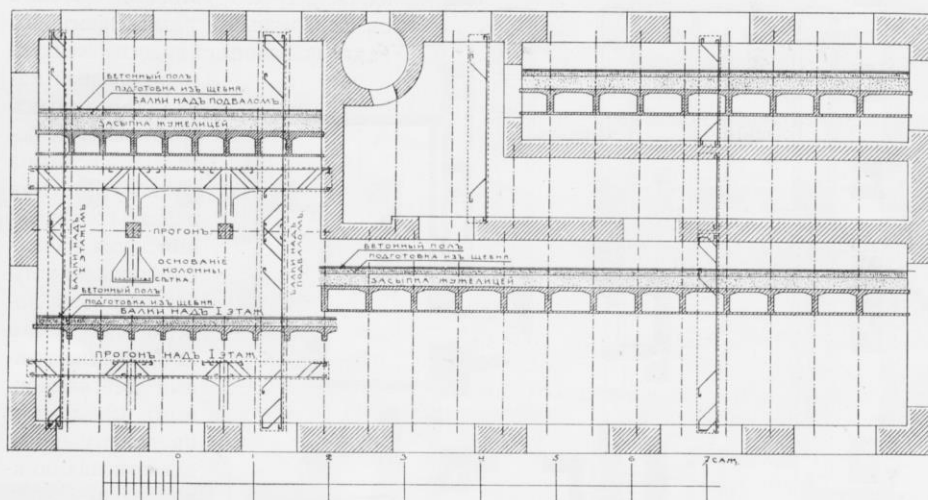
Подвалъ Станціи. Желѣзо-бетонная конструкція перекрытія подвала.
